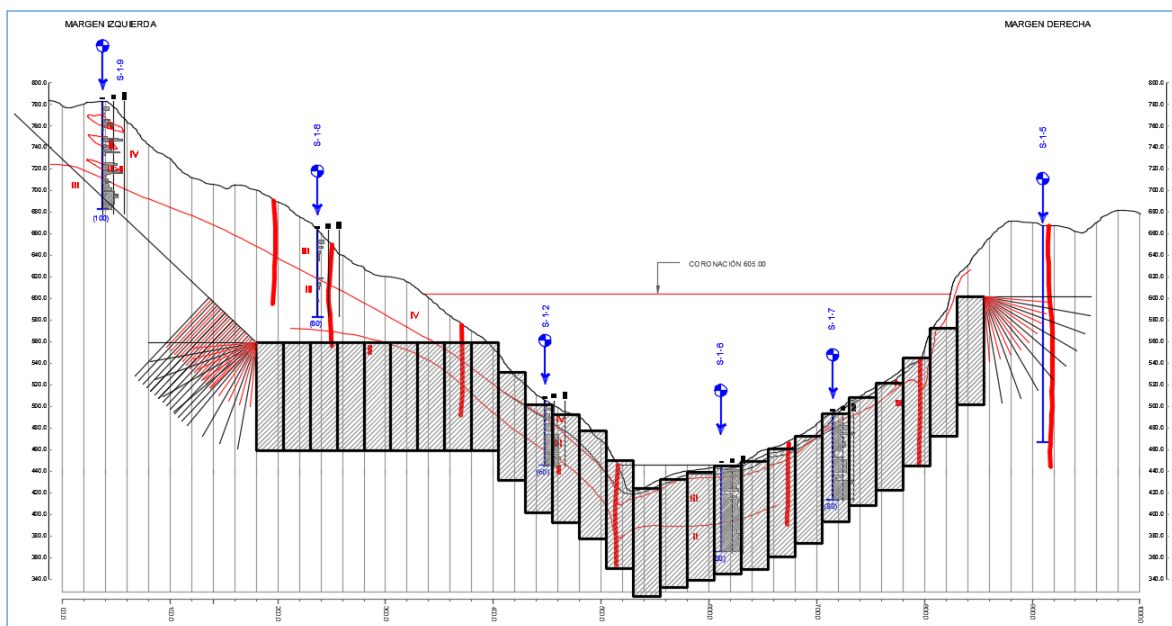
Esquema de la disposición de la pantalla de impermeabilización en el eje longitudinal de la presa
